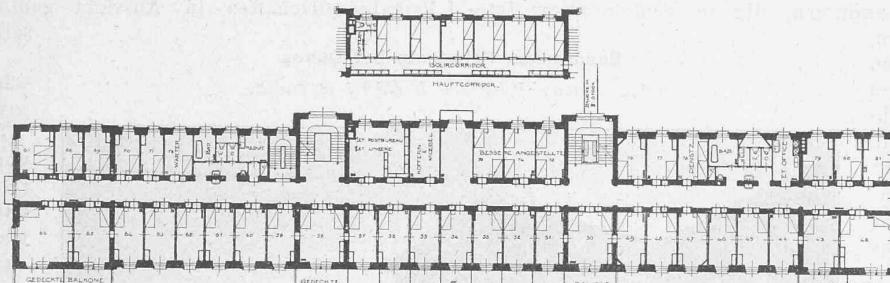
Grundriss von den oberen Geschossen. — Maßstab 1:750.
